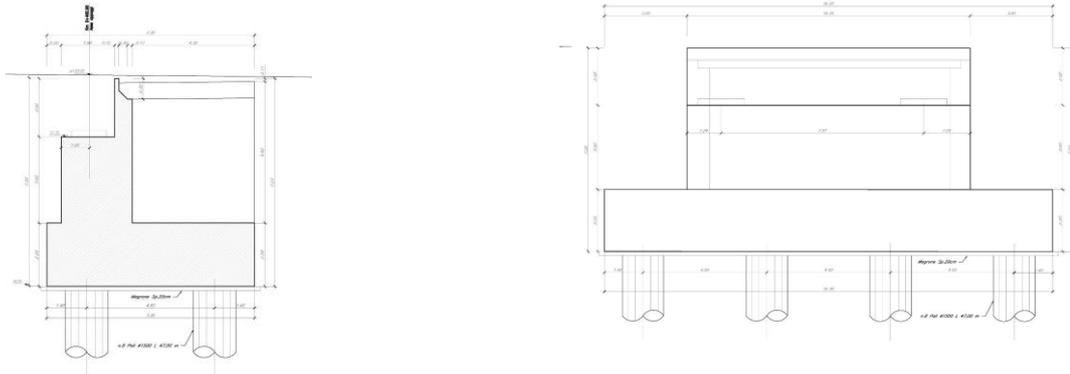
Sezione longitudinale spalla (sinistra) e Sezione trasversale della spalla (destra)
